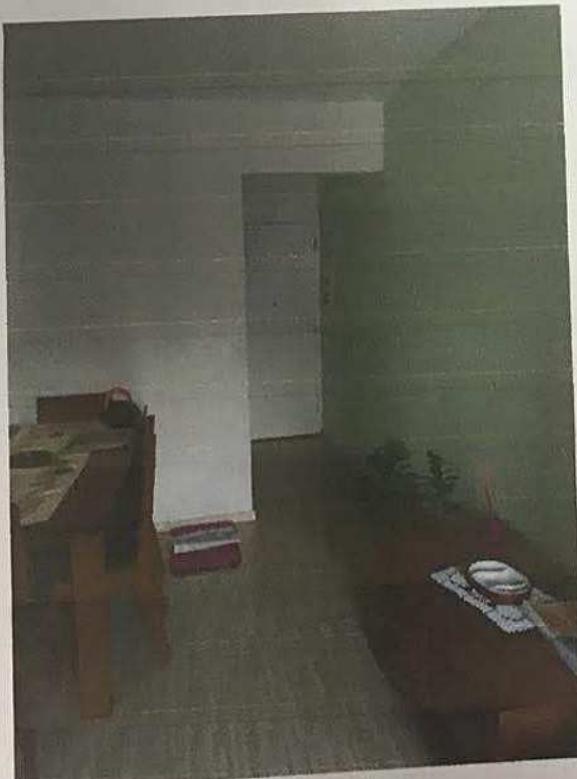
Vista da sala da unidade, visando a porta de entrada. Observar acabamento de piso, paredes e teto.
